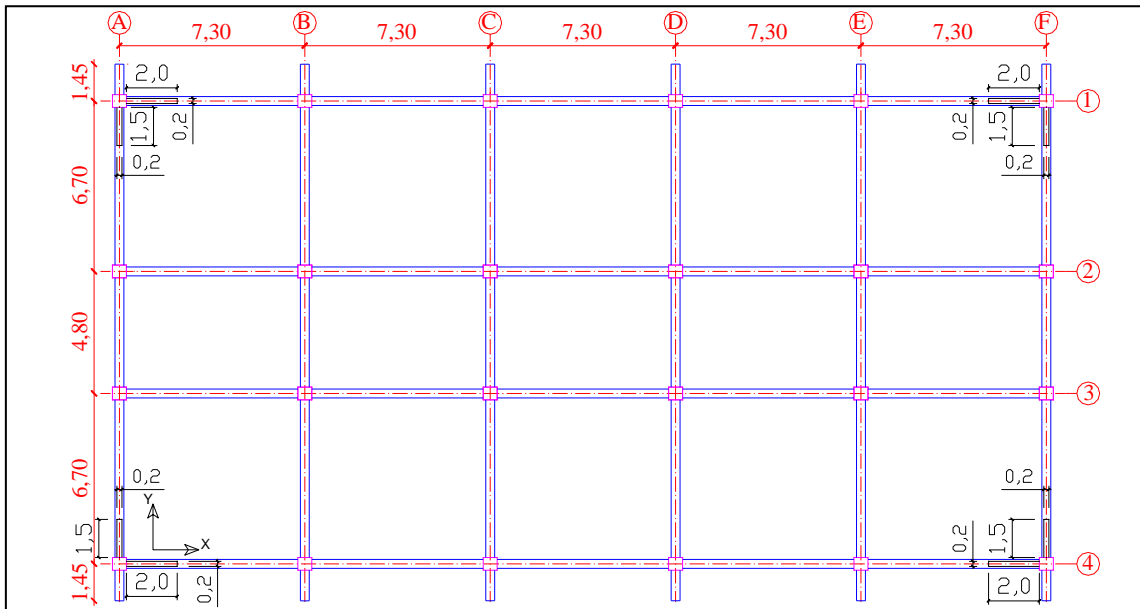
Distribución de los muros en planta, alternativa 1.
